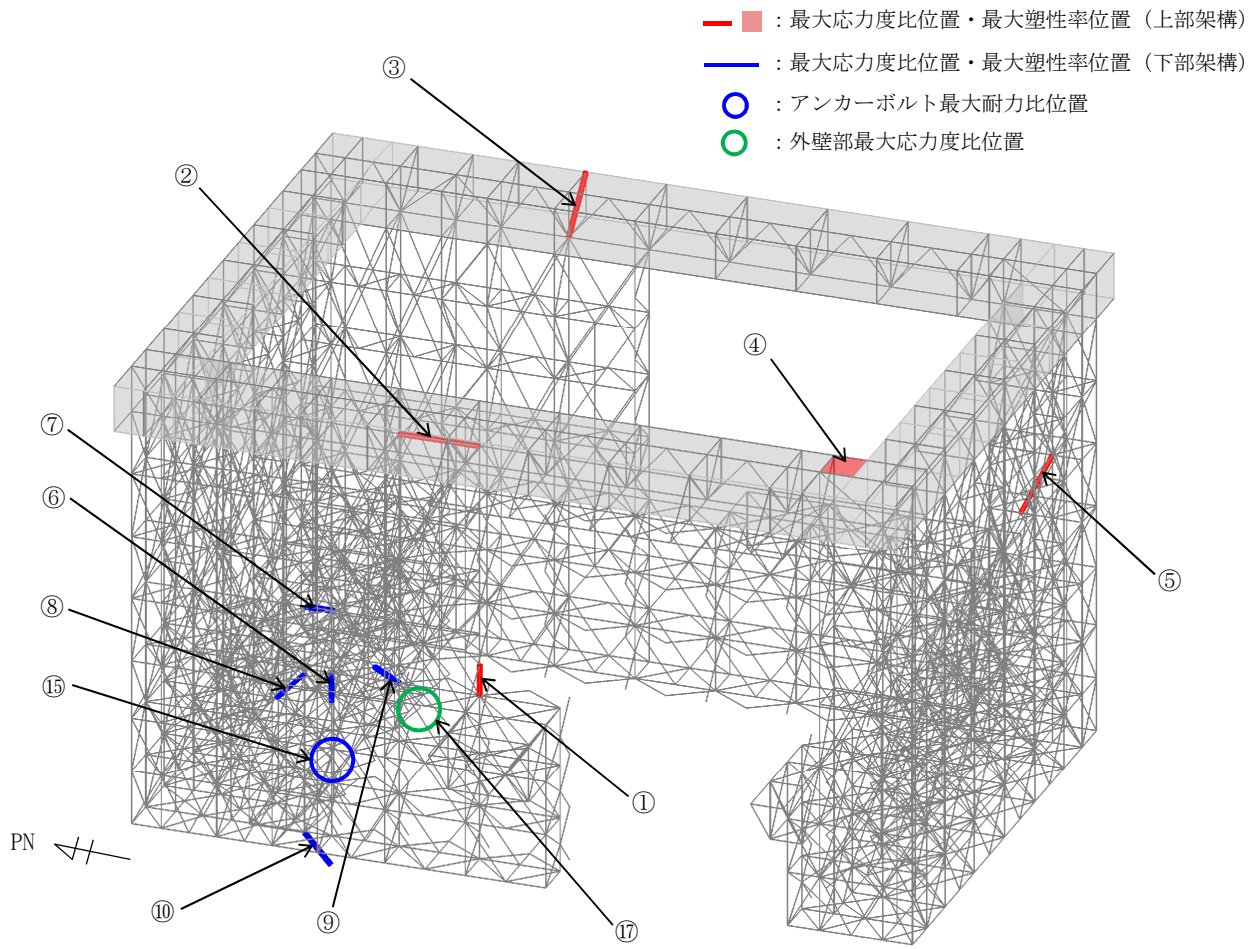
(1) 最大応力度比位置図(一般部, 1/2Ss450 地震時)
